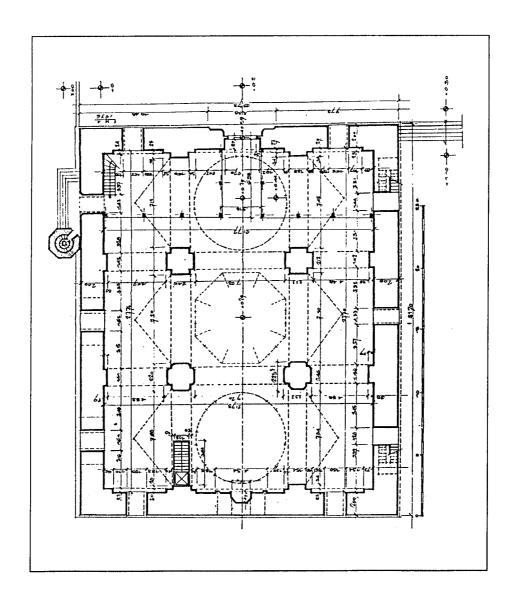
مسقط أفقي لمسجد بايزيد الثاني في بيرات بألبانيا (عن : كيل)
